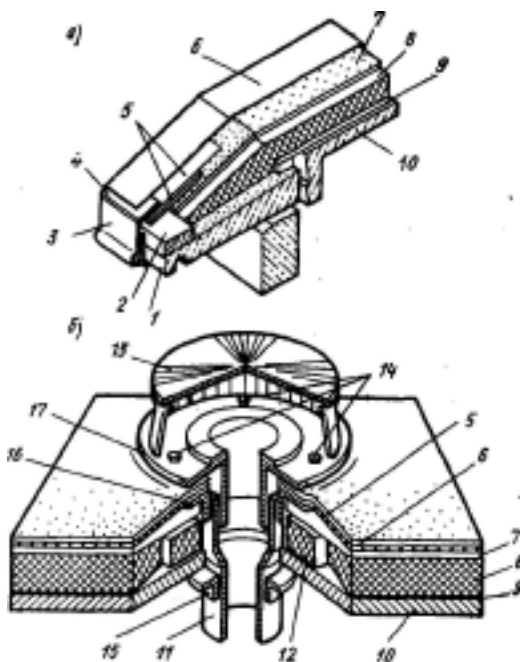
Конструкции отвода воды с покрытий промышленных зданий:
